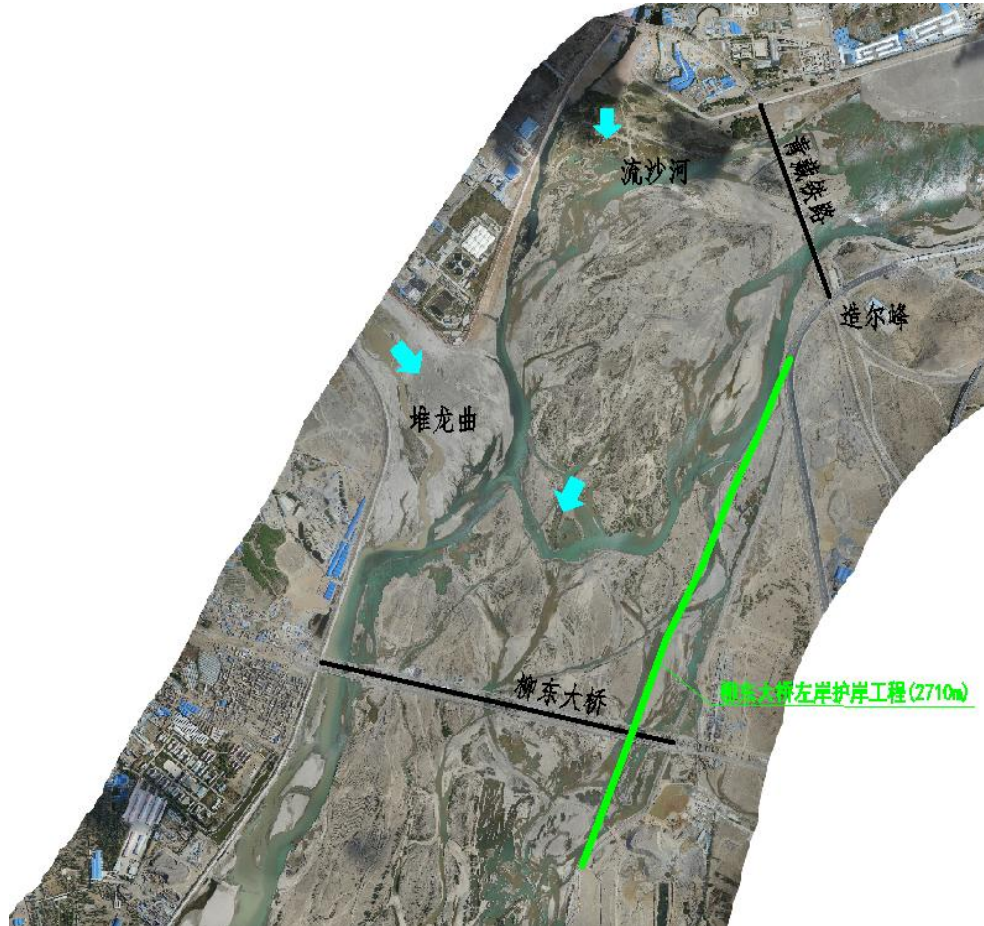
柳东大桥段护岸工程平面布置示意图
